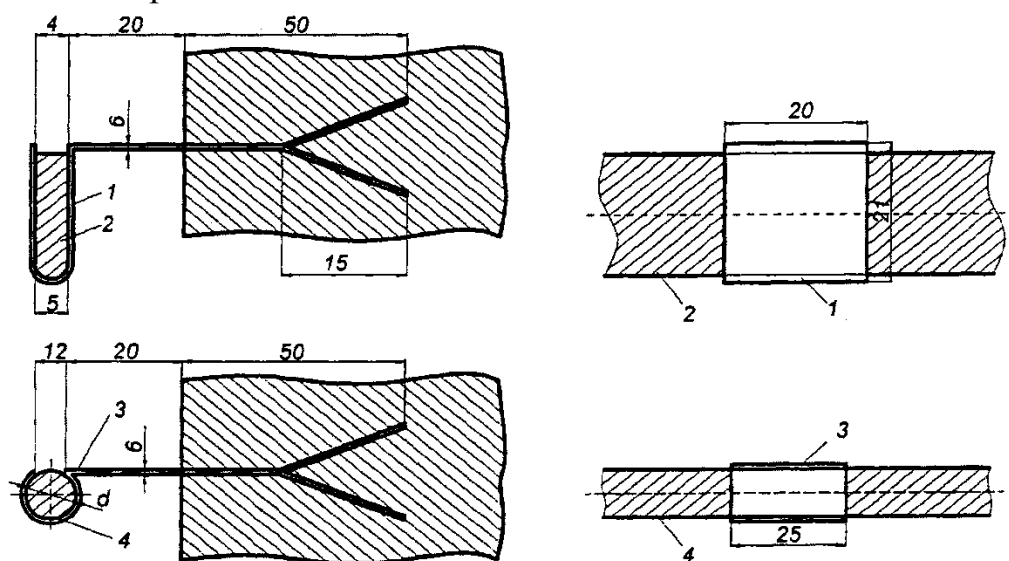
Схема крепления заземляющих проводников в камере с бетонной крепью:
